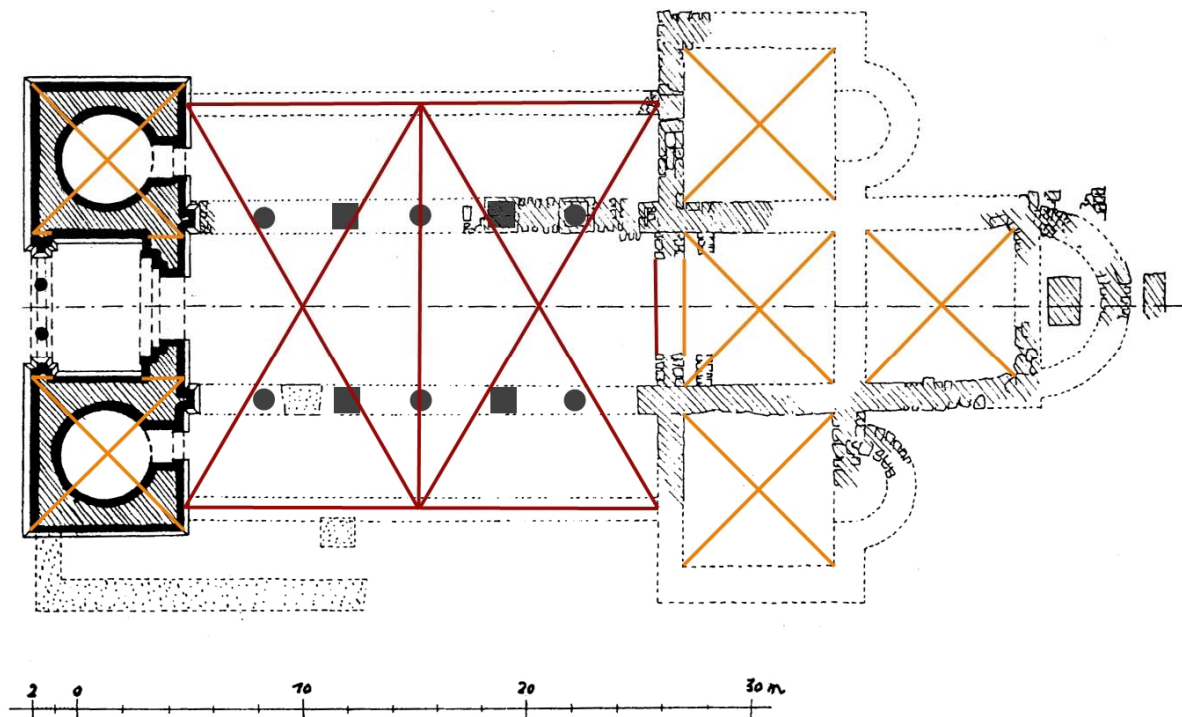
Hildesheim, Andreaskirche, Grundriss mit isogonalem Absteckdreieck (rot) und Proportionsquadraten (gelb). Grundlage: WILLE, Pfarrkirche (wie Anm. 17) S. 46.
